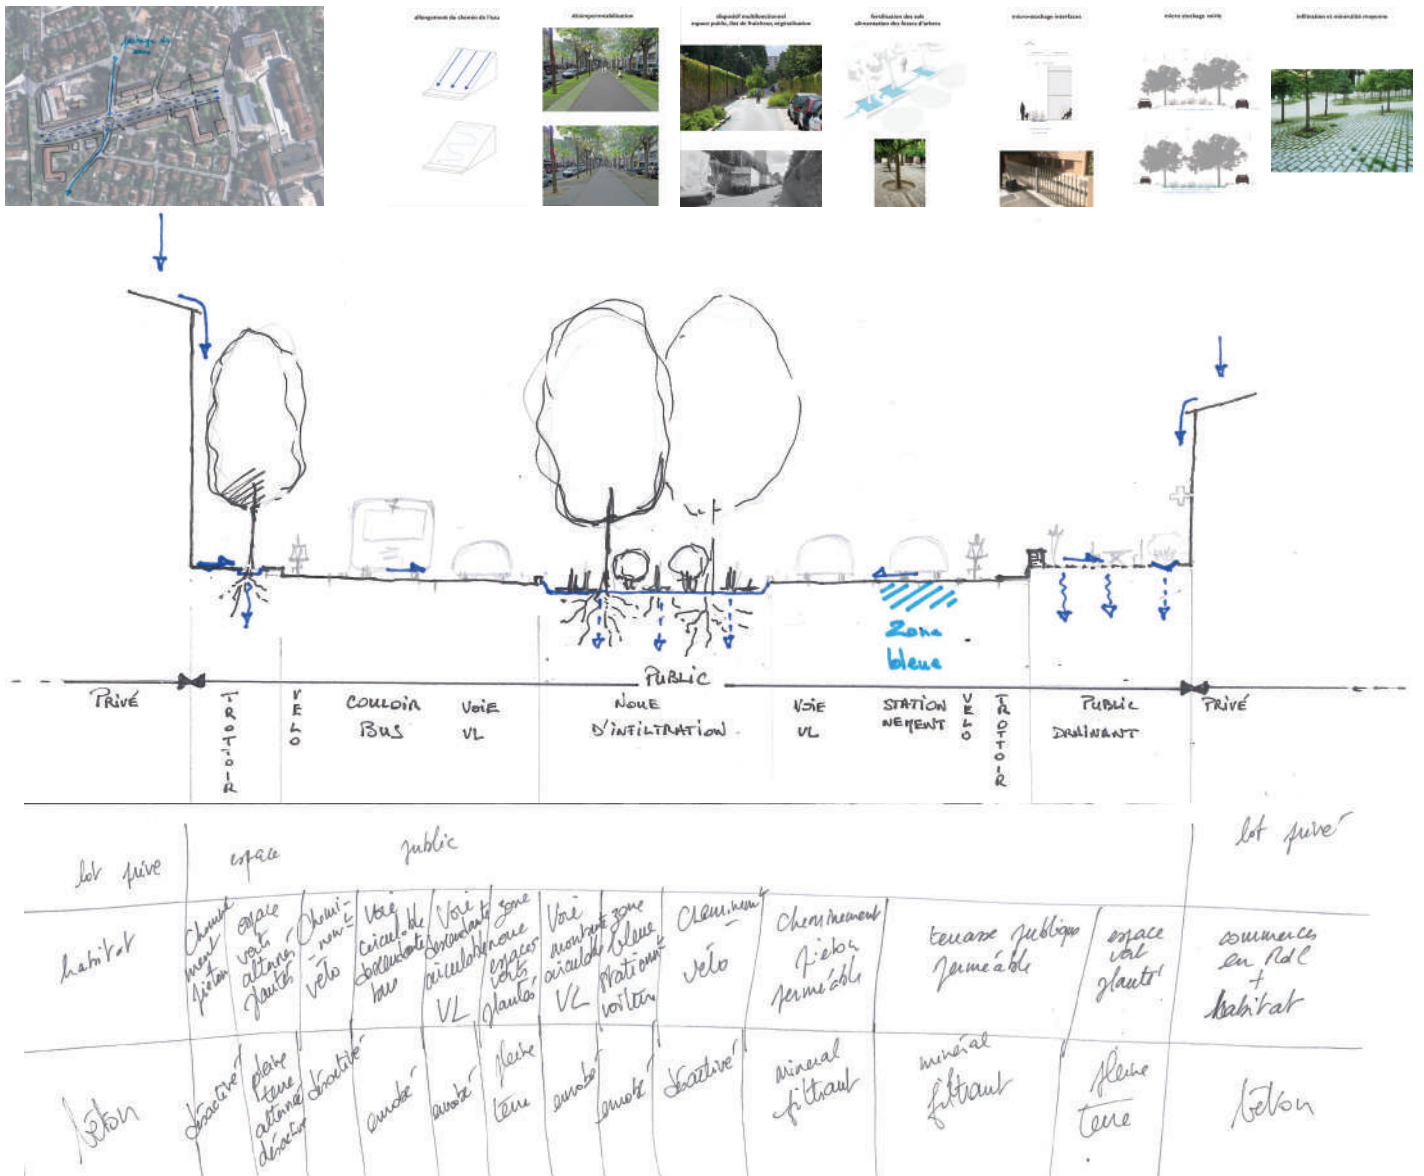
La coupe en travers des «architectes paysagistes» sur l'avenue Winston Churchill à Aix-en-Provence
